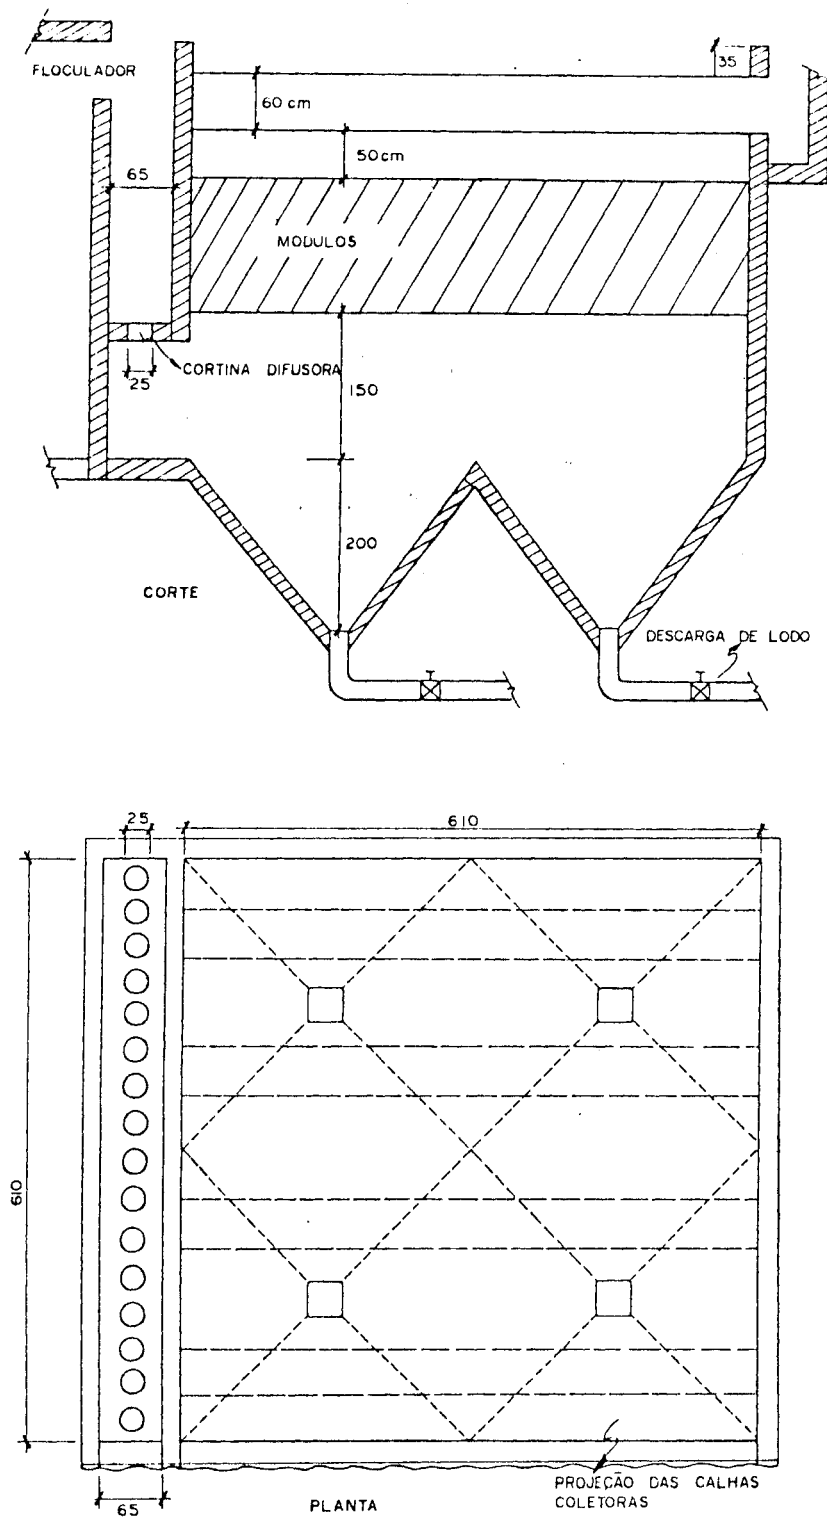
Detalhes de estrutura de entrada em decantador laminar.
